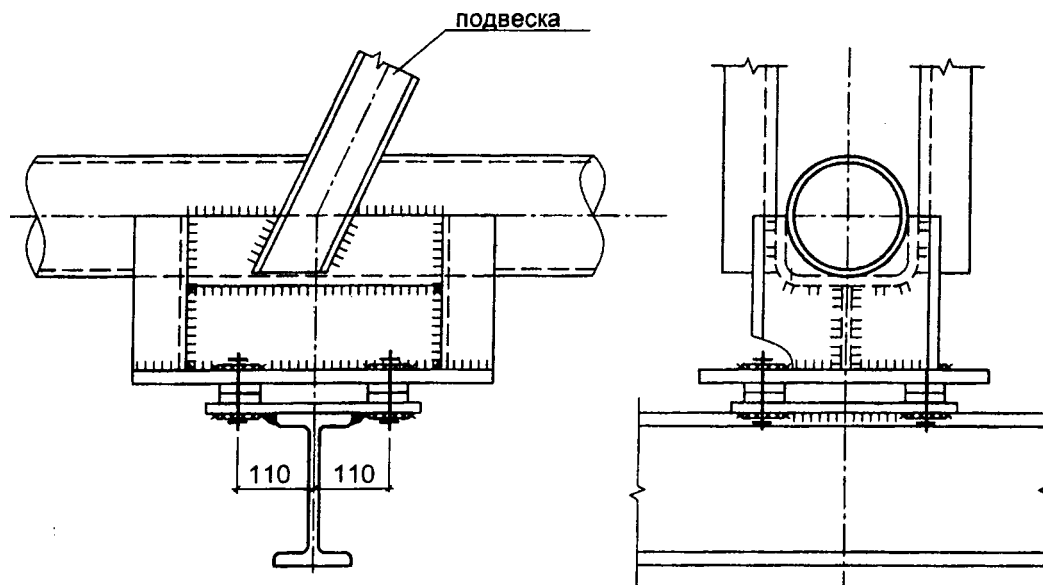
Крепление путей подвесного транспорта к фермам из круглых труб
